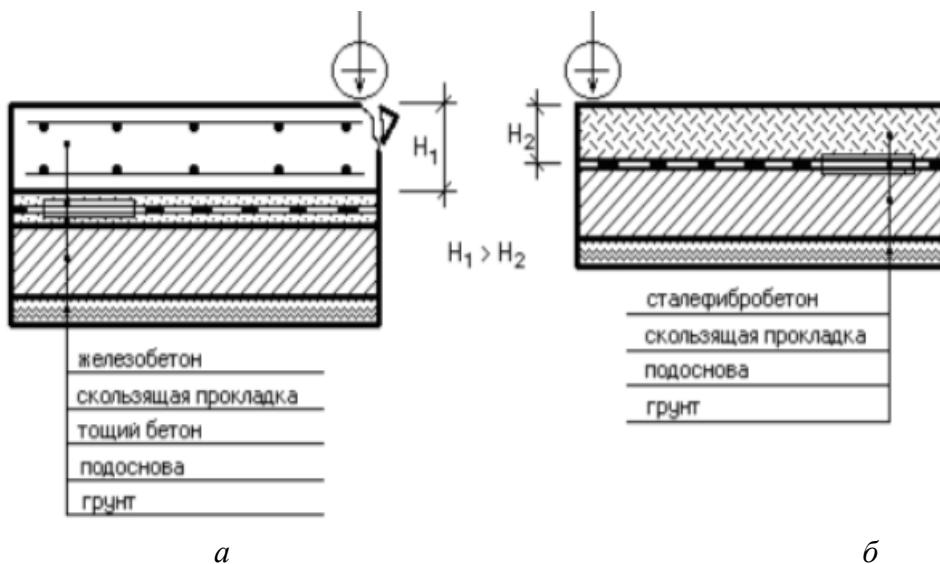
Конструкции дорожного покрытия:*а* – классический железобетон;
